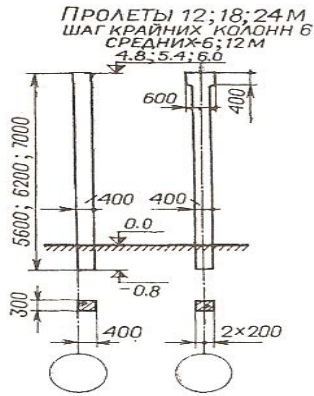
Типы железобетонных колонн для бескрановых зданий
